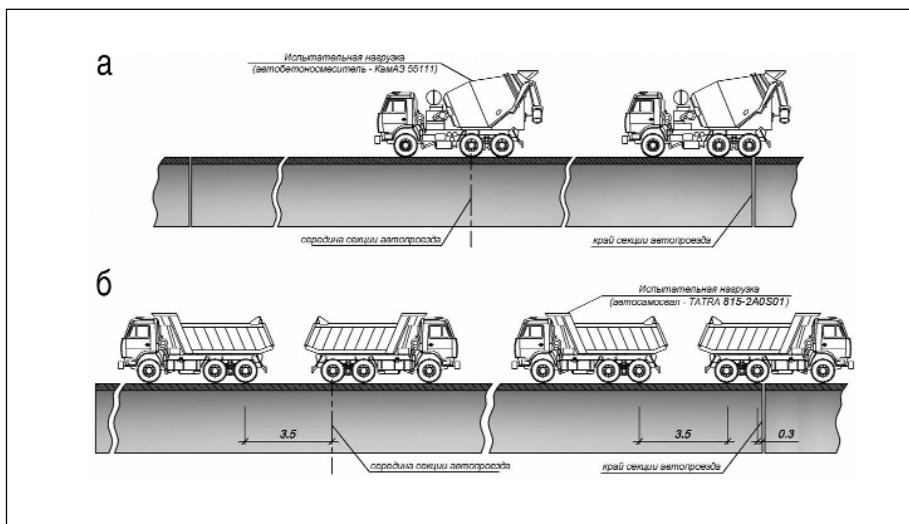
Схема расстановки испытательной нагрузки по длине конструкции автопроезда на различных этапах испытания: а – при бетонировании перекрытия, б – приемочные испытания
